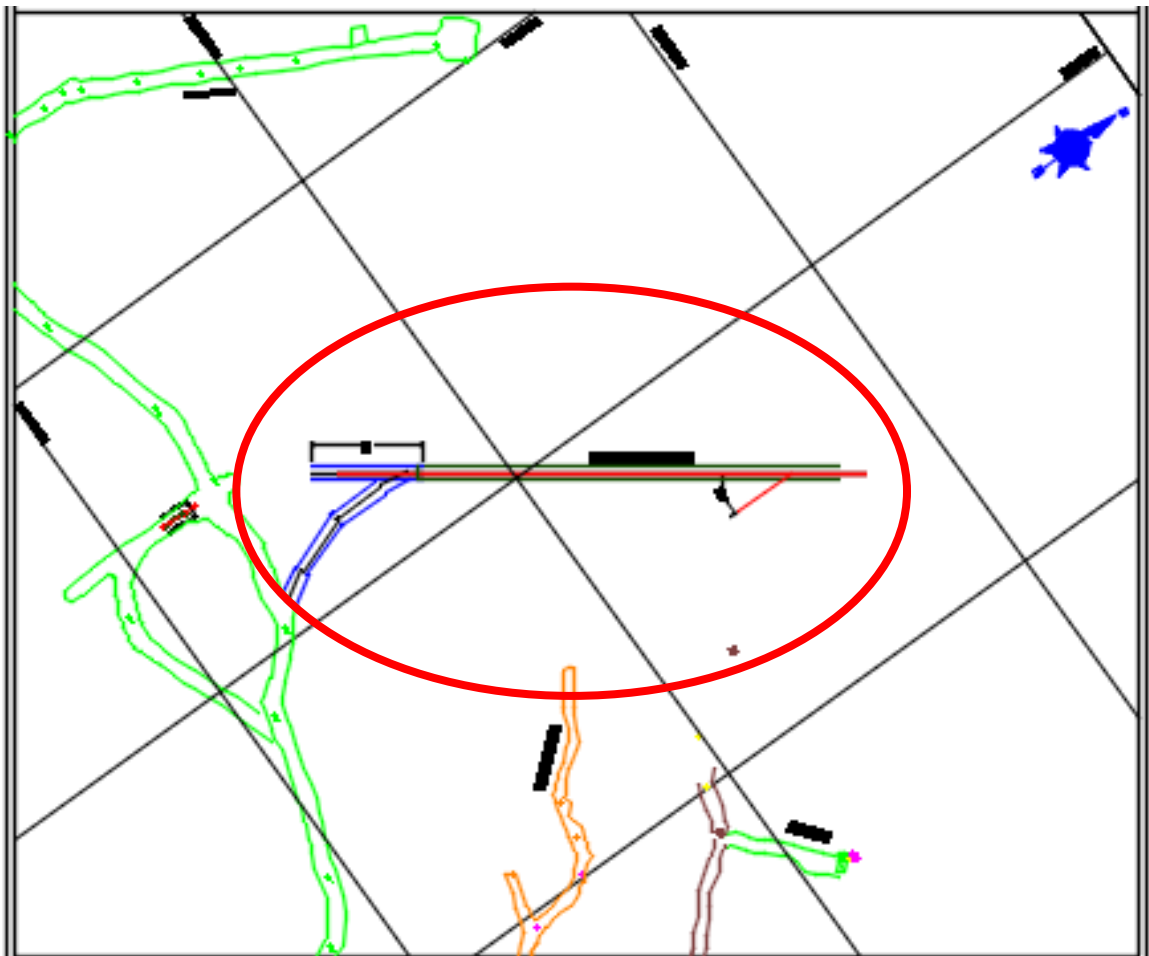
Plano topográfico donde se plantea realizar el pique inclinado
